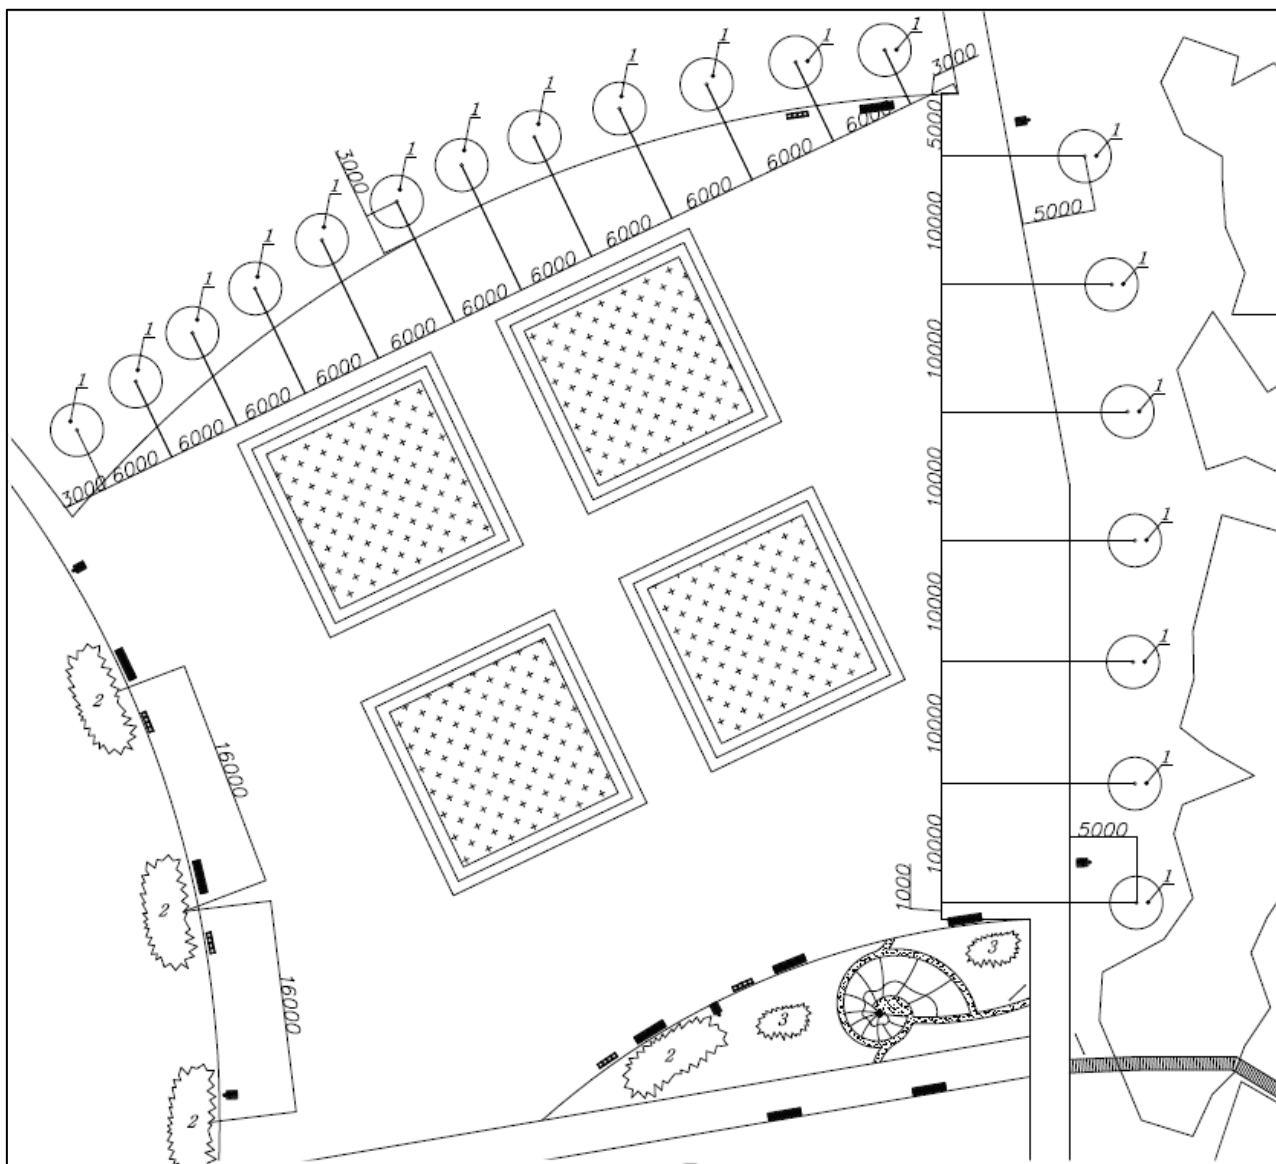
Фрагмент генплана 11, схема посадки растений для площадки с сухим фонтаном
